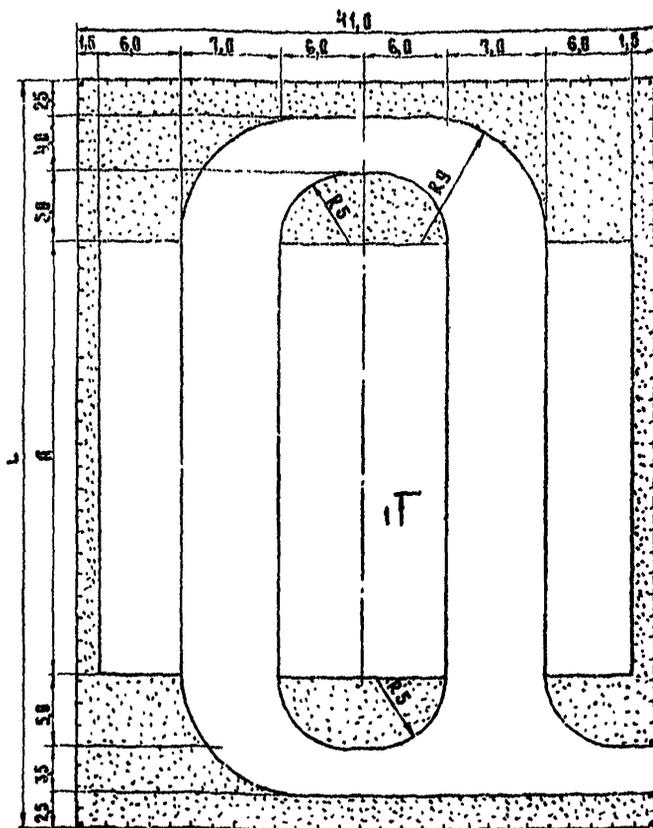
Схема генерального плана хранилищ на 800-3200 т использованием на погрузочных работах автокрана КС-256Ц.
